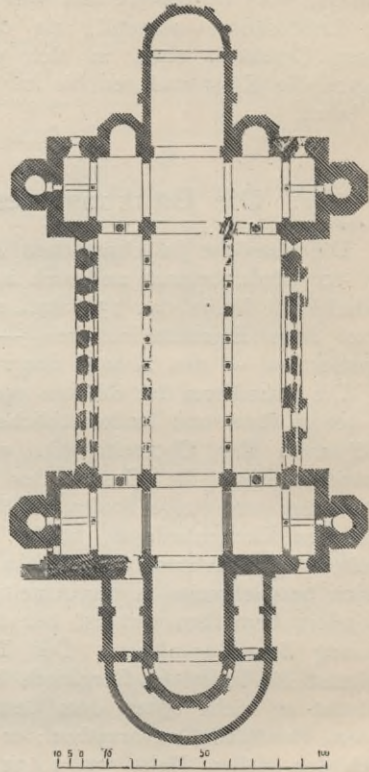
Grundriss von St. Michael in Hildesheim.
